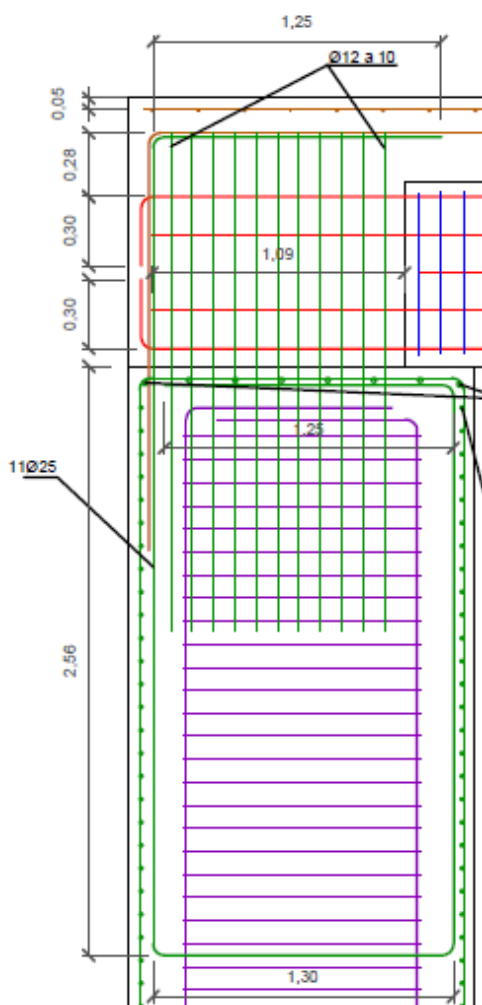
Armadura de junta plataforma, apoyo defensa y gancho de amarre.
